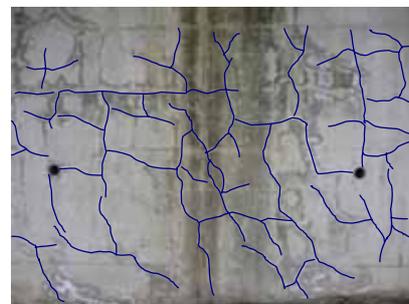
ASR によるひび割れ発生状況(ひび割れをトレースして強調)
